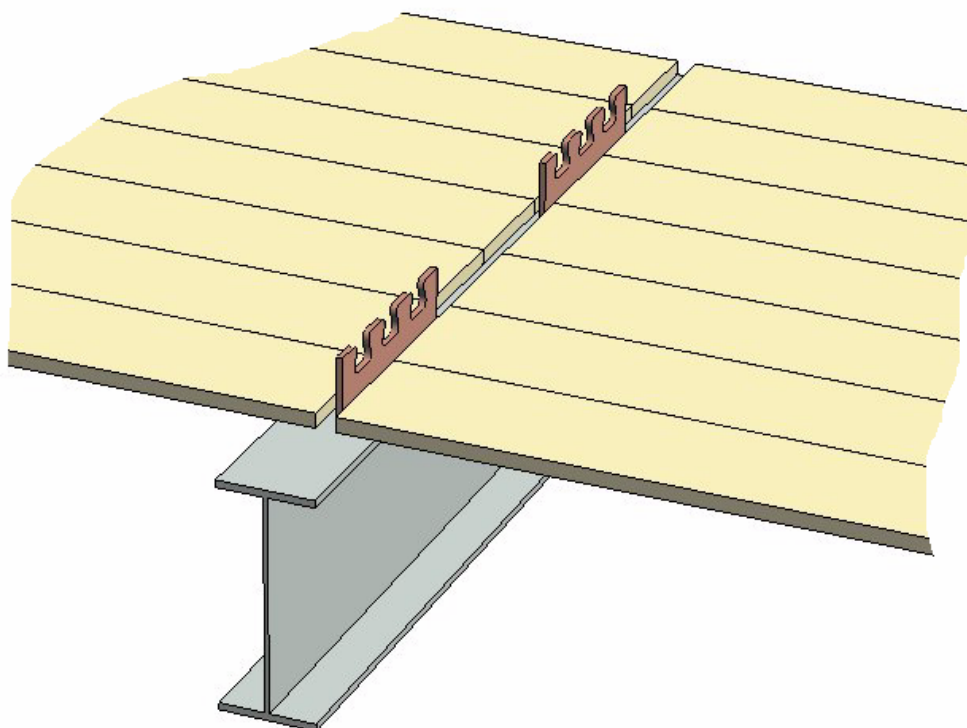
O conector Crestbond aplicado com pré-laje de concreto pré-fabricada.
